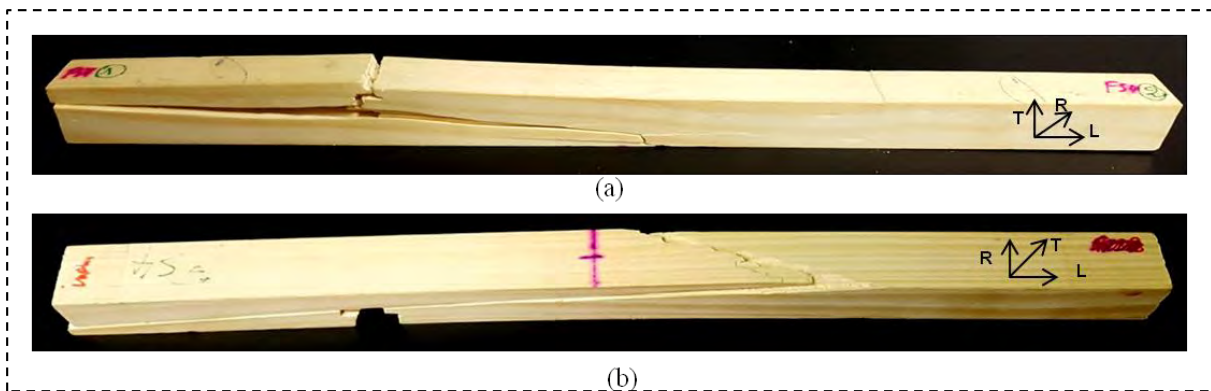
Faciès de rupture de l'éprouvette FS4 (a) face avant LT (b) face tendue LR
